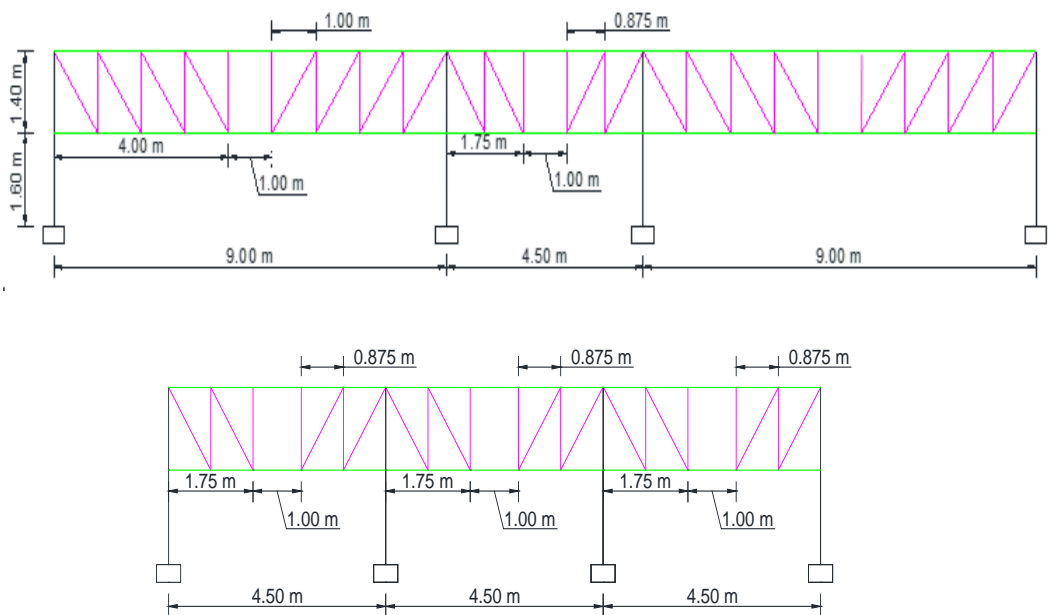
Configuración de los pórticos con viga reticulada y el segmento especial Vierendeel en la dirección Y.
